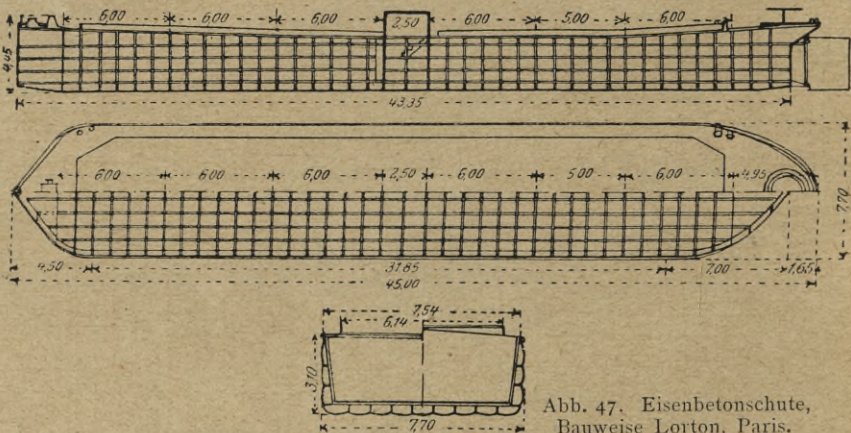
Eisenbetonschute, Bauweise Lorton, Paris.
